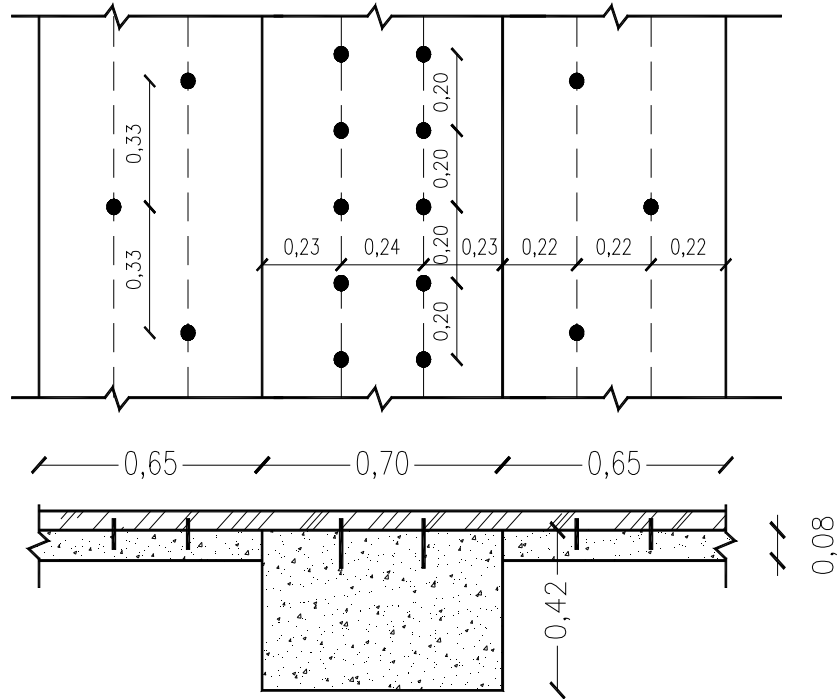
Refuerzo para esfuerzos rasantes en pórticos estructurales
